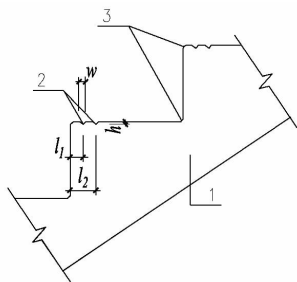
预制楼梯梯段板踏步面防滑条构造示意
